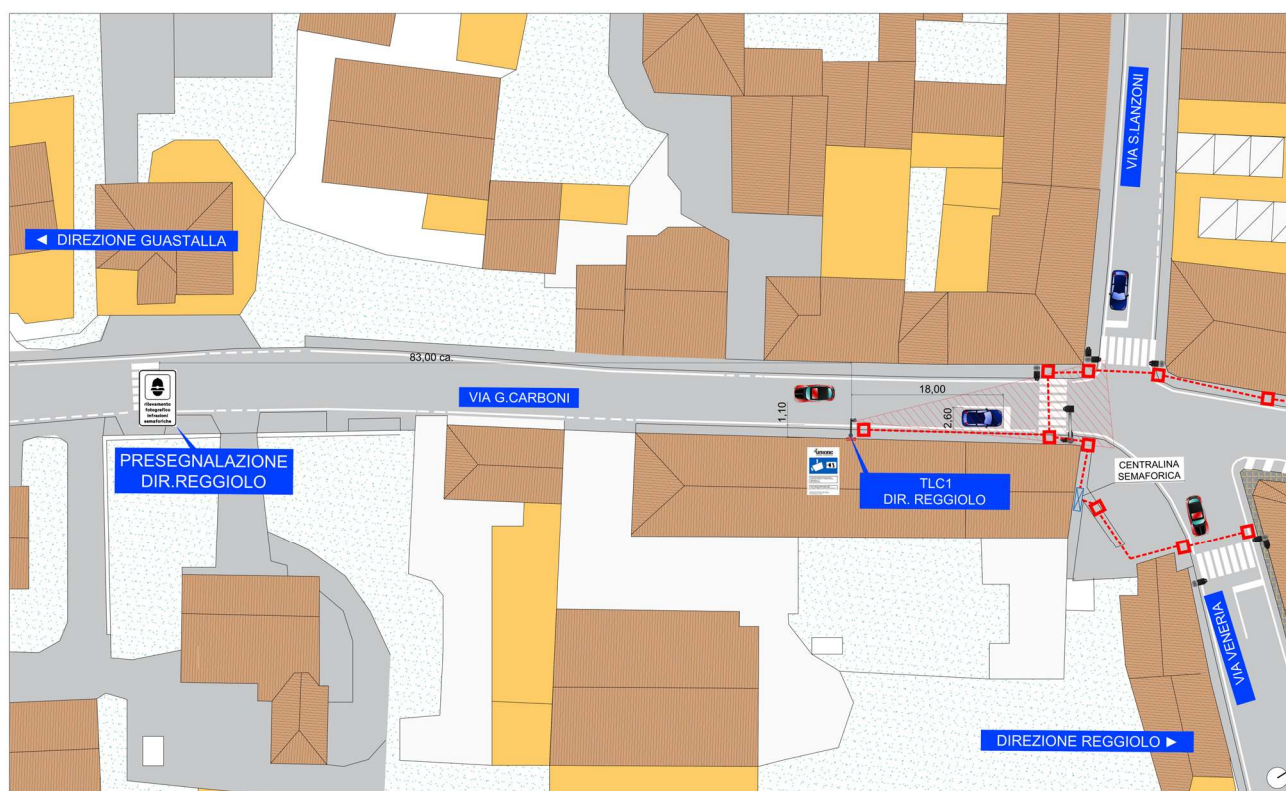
Planimetria di dettaglio TLC1 – Via G. Carboni in direzione Reggiolo
